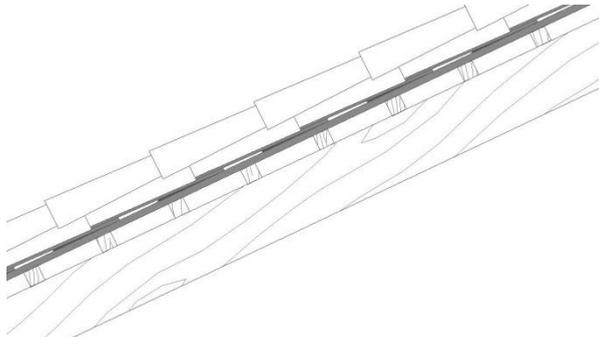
Detalle tipo de cubierta desaparecida - Fuente propia
